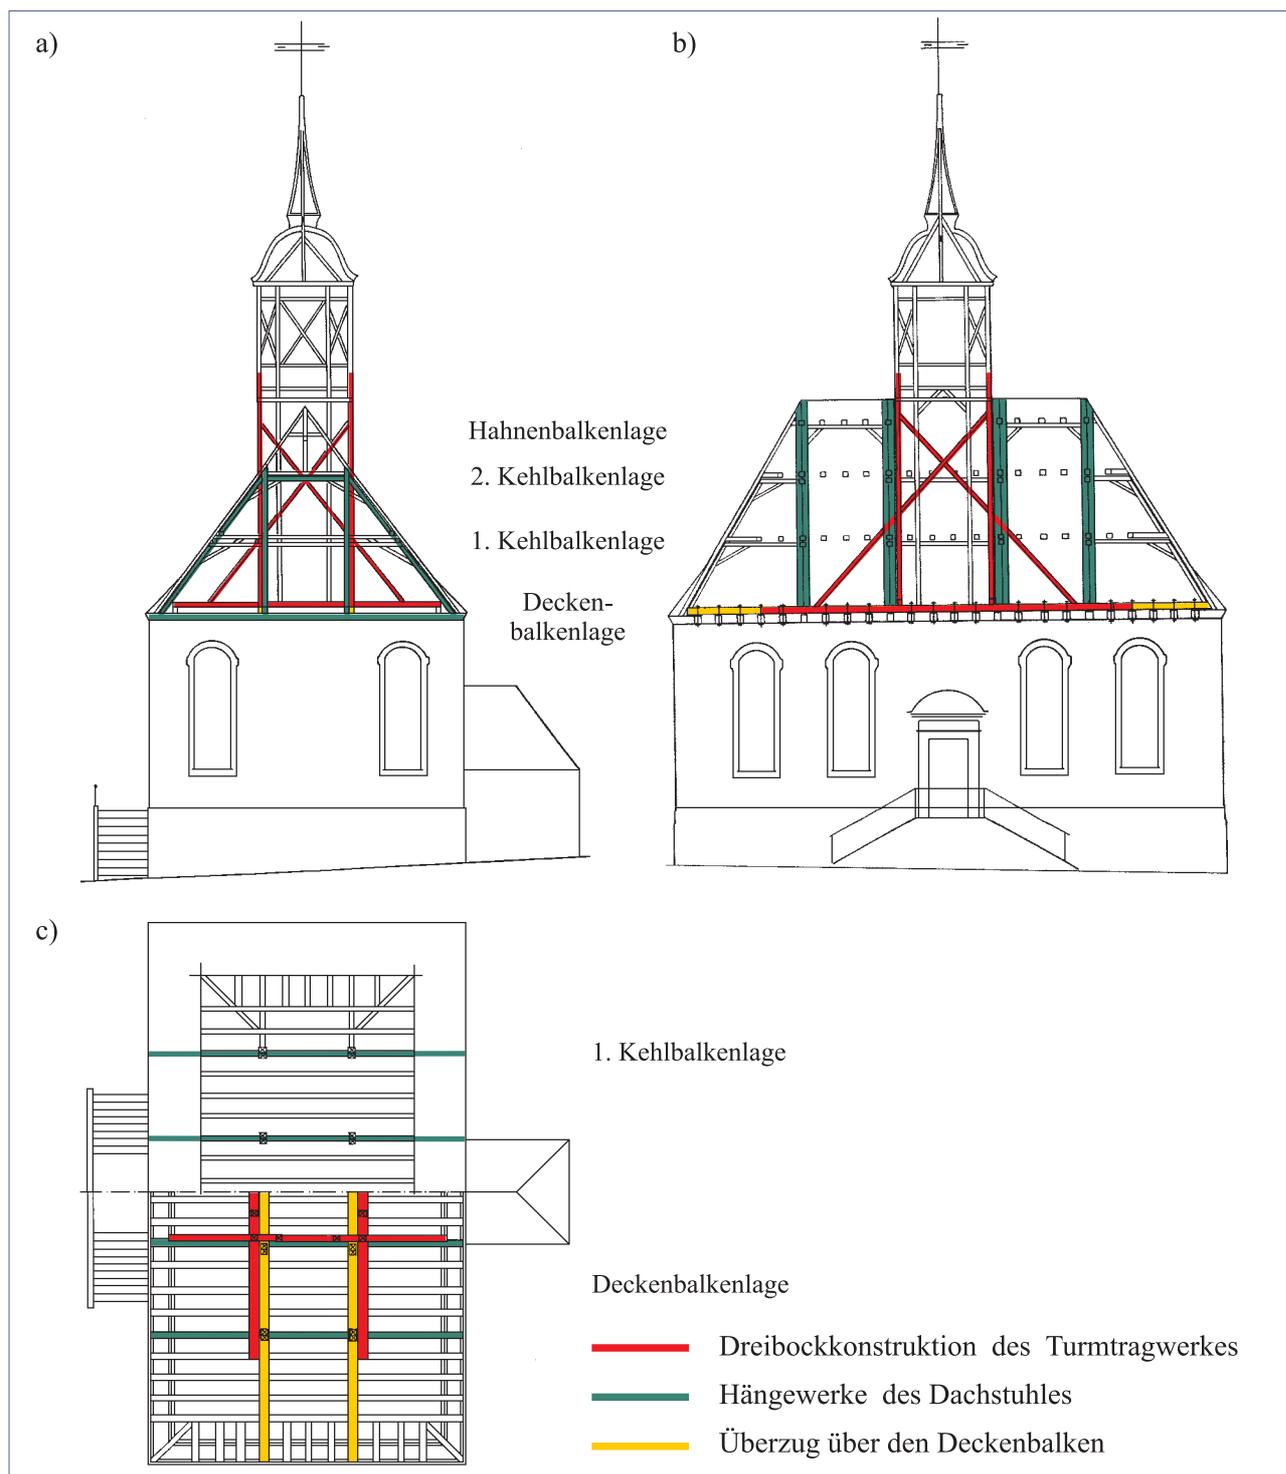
Weinbergkirche zu Dresden - Pillnitz - Haupttragglieder des Turm- und Dachtragwerkes, Dreibockkonstruktion des Turmtragwerkes und Hängewerke des Dachstuhles, Bezeichnung der Balkenlagen.
